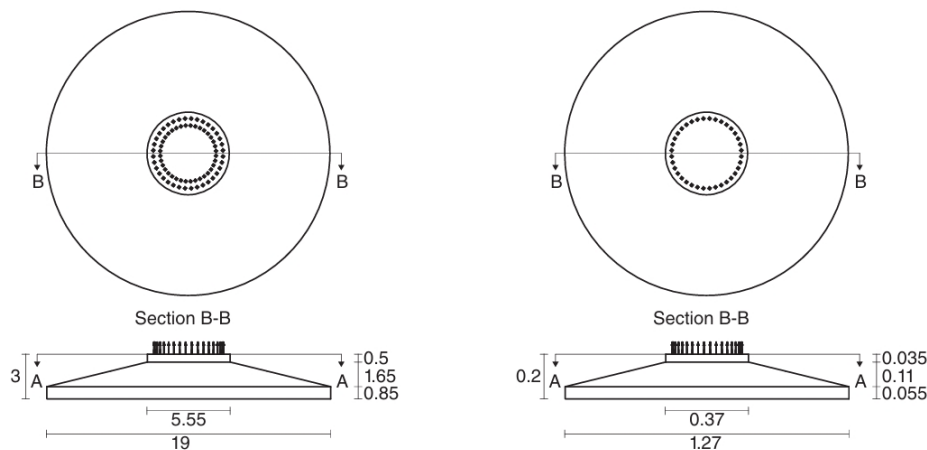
Geometria reale (sx) e in scala ridotta (dx) della fondazione [m] [6]
